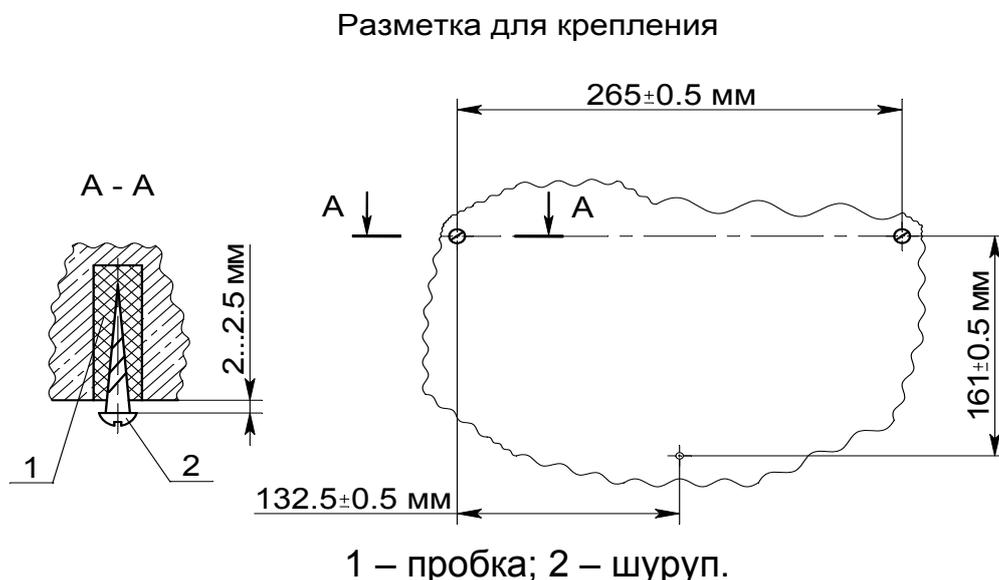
Разметка для крепление ФОРВАРД32 на вертикальной стене
